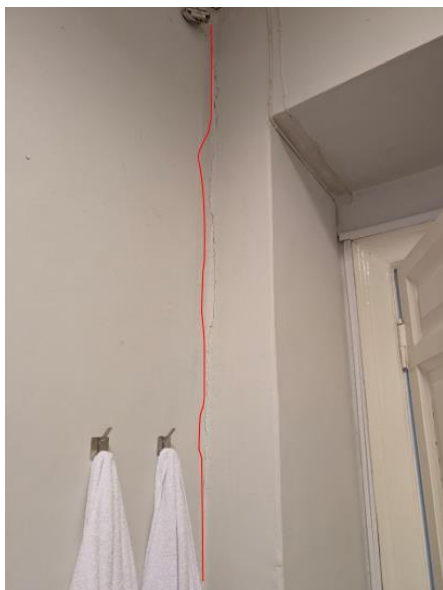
Трещина на стыке стены и перегородки коридора, помещение по плану №8, 3 этажа помещения 8-Н
